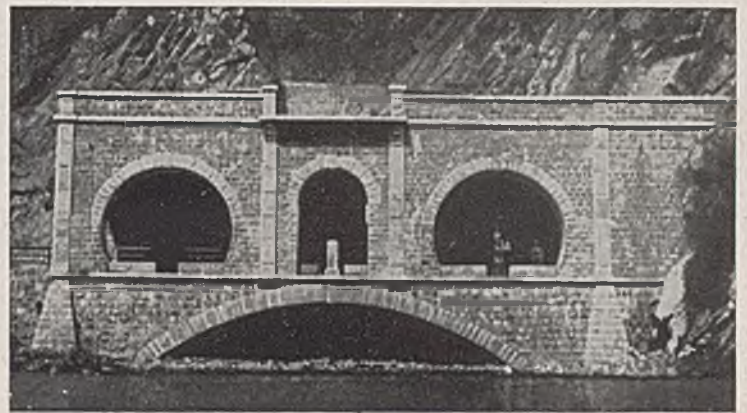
Straßenbrücke mit darüber liegendem Tunnel.
